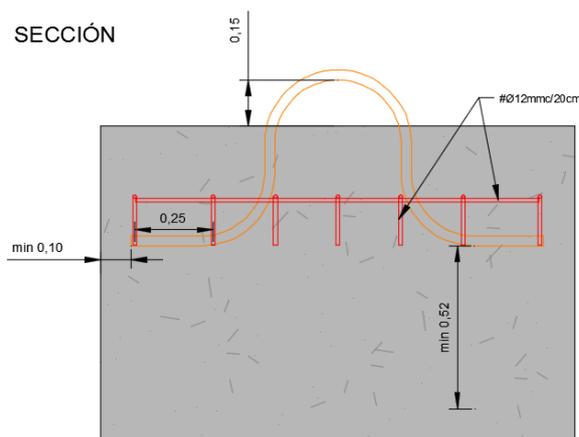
Detalle de arganeo y armado de enganche de muerto de amarre
